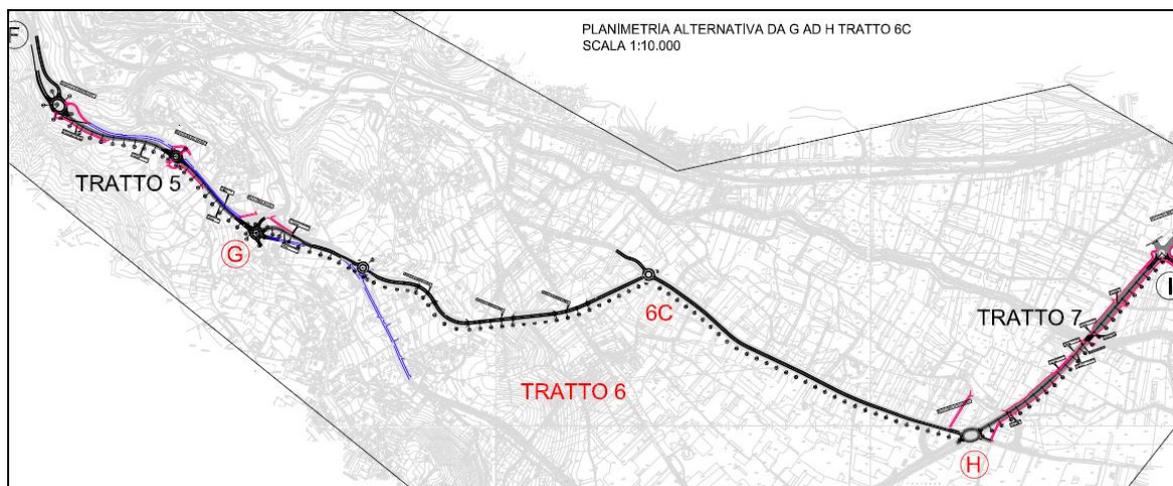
Planimetria LOTTO B con Alternativa di progetto 6C
